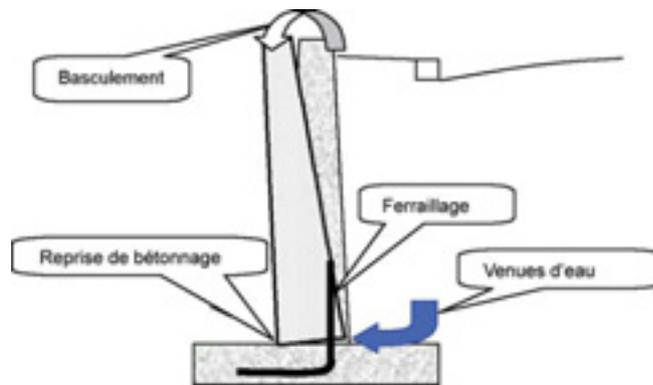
Basculement d'un mur consécutif à une rupture du ferrailage par corrosion au niveau de la reprise de bétonnage.
